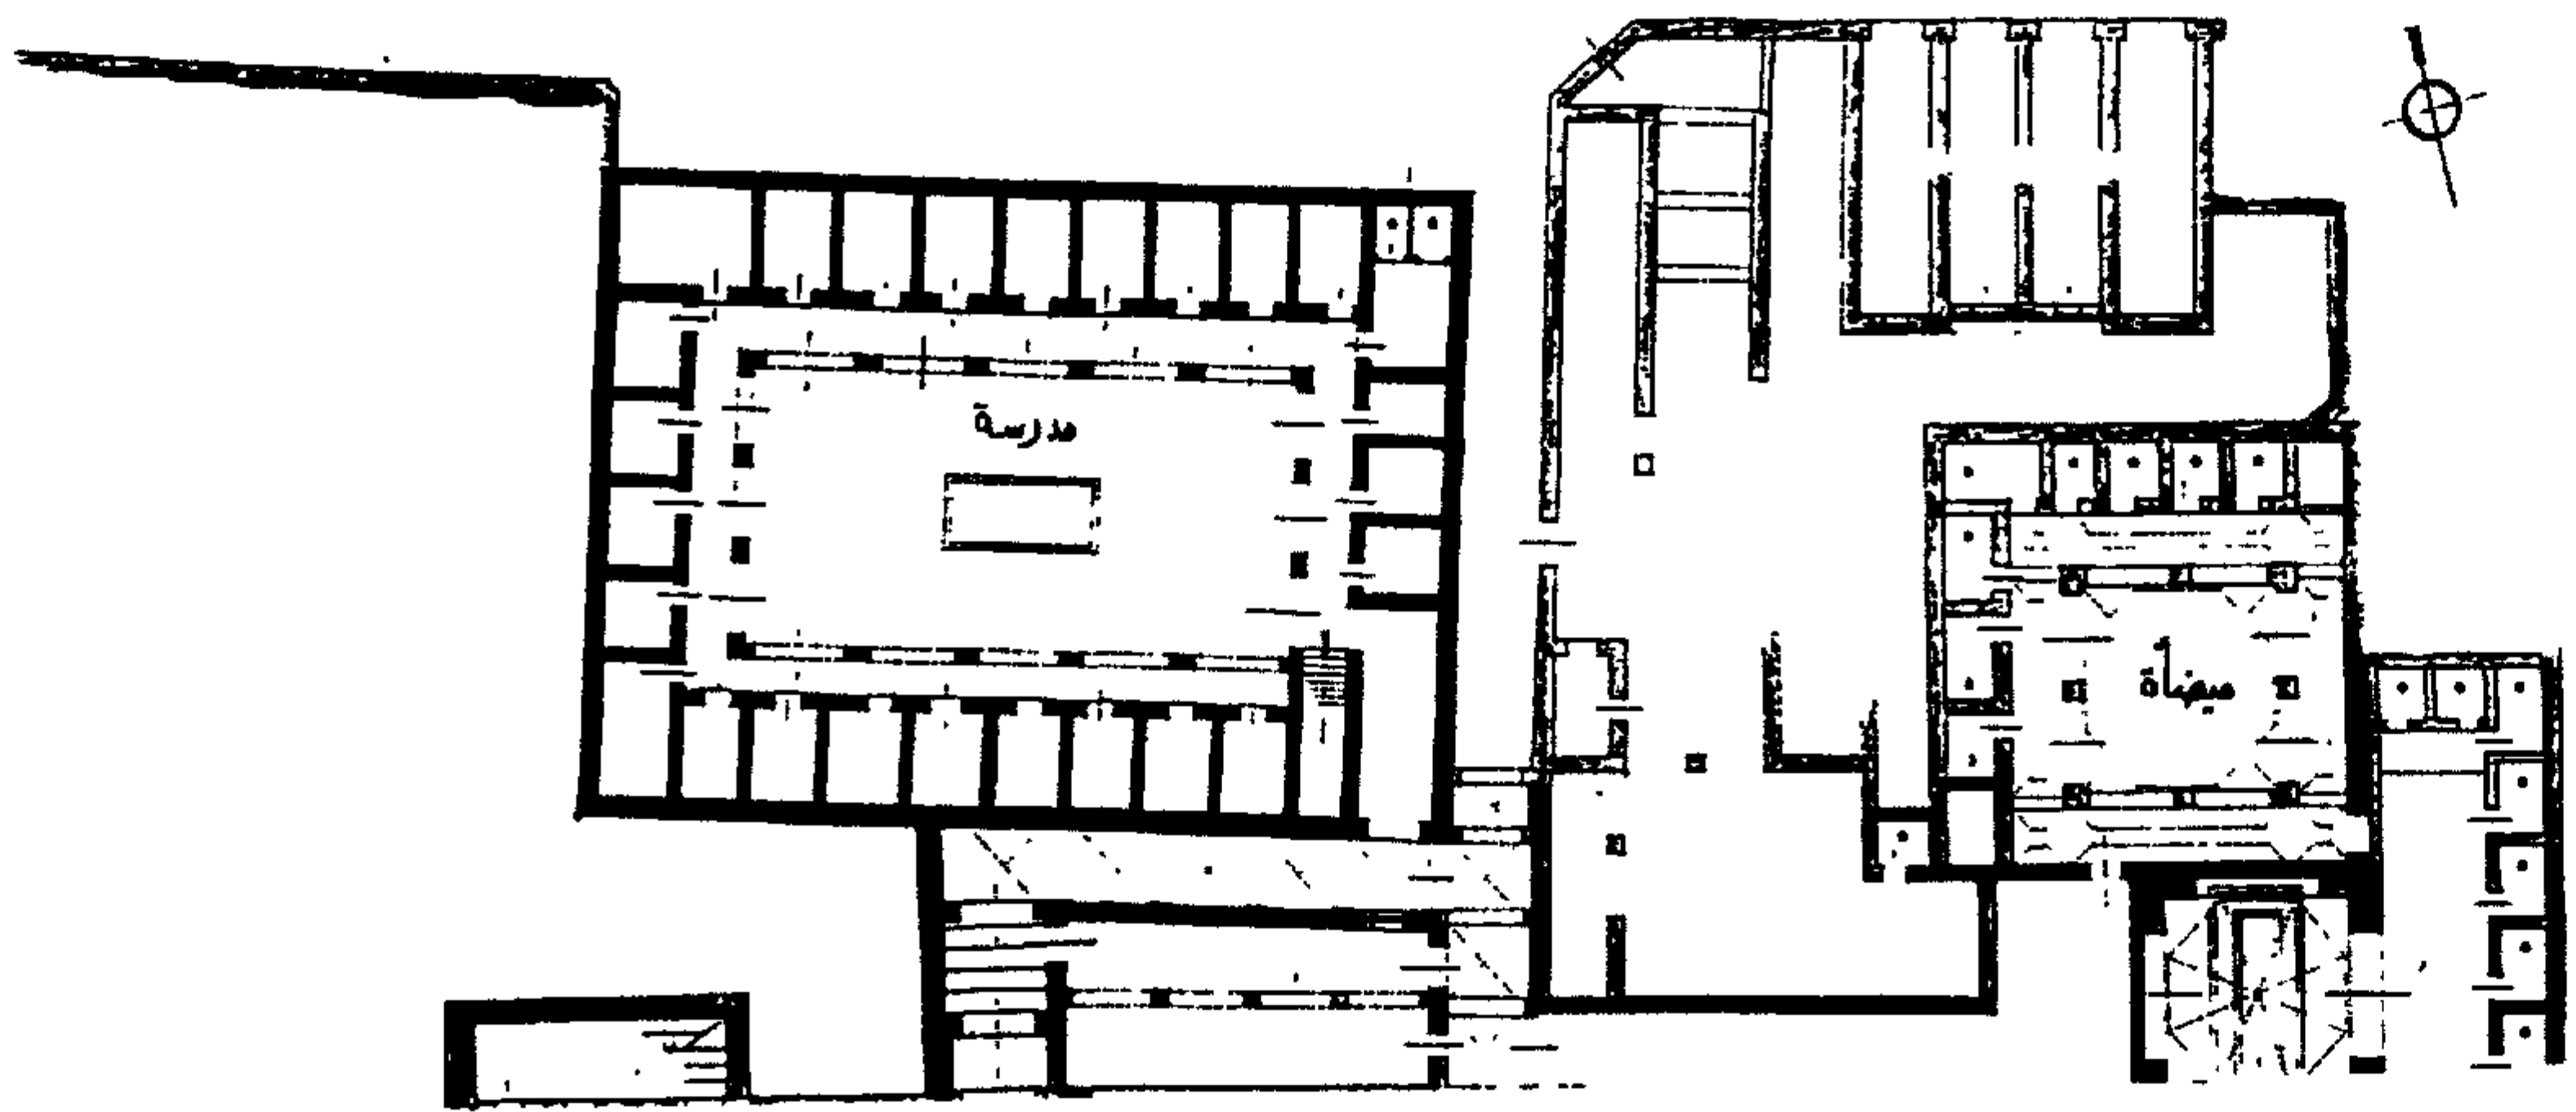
مسقط أفقي للتخطيط الحالي لمدرسة جامع باب دكالة بمراكش.
